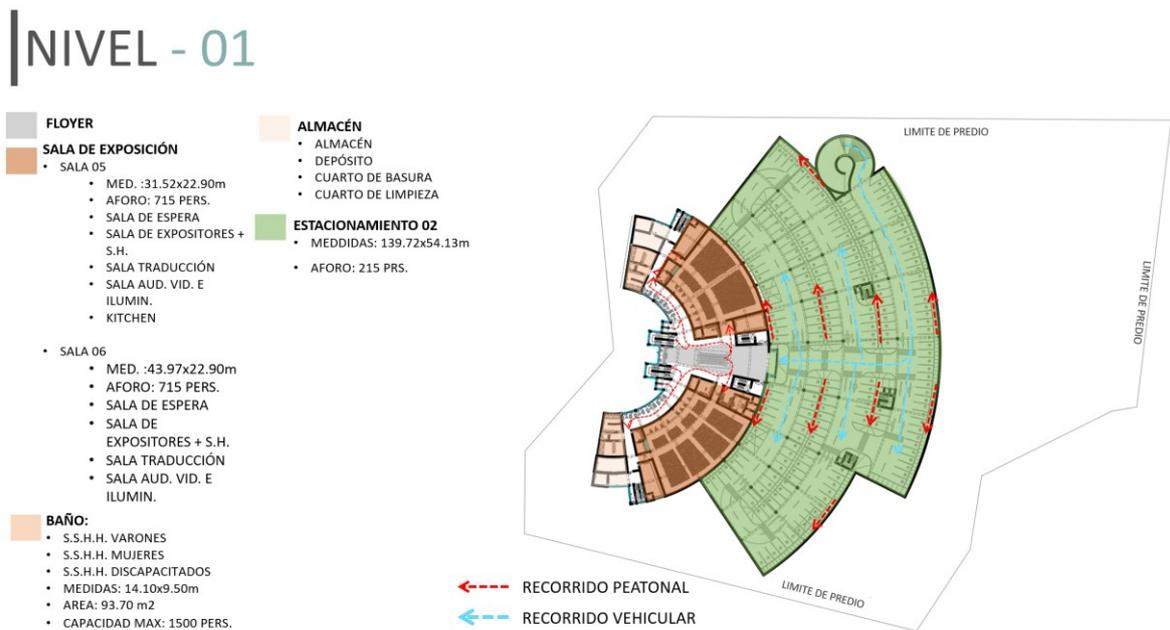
Plano de distribución del nivel -01: sector 01 y sector 03.
